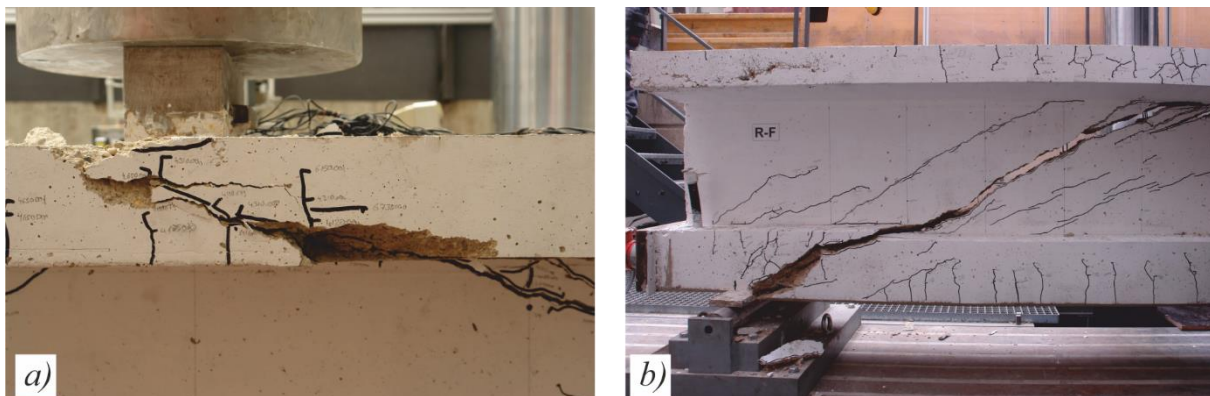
sekundäres Betonversagen: a) Lasteinleitungsbereich Träger I-15-2; b) Auflagerbereich Träger I-22-1
